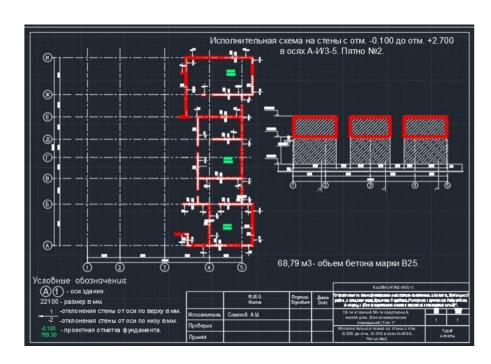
Фрагмент исполнительной съёмки на стены и фундамент в среде AutoCAD (чертёж автора)
